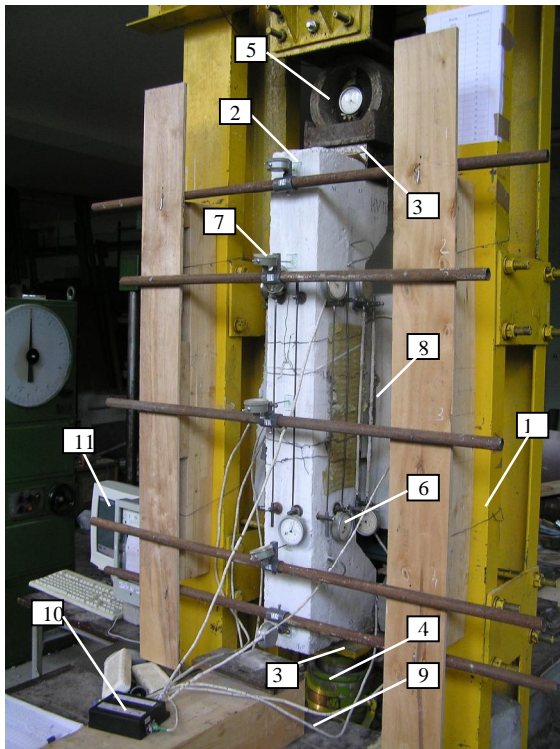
Стенд для випробувань залізобетонної колони, за дії місцевого нагрівання з боку стиснутої зони бетону:
